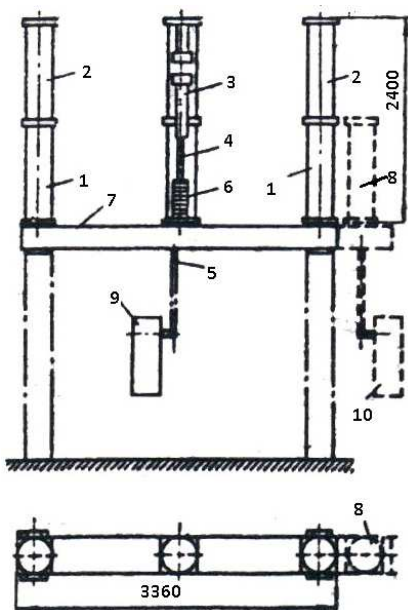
Установка выключателя нагрузки 110 кВ с элегазовыми камерами
